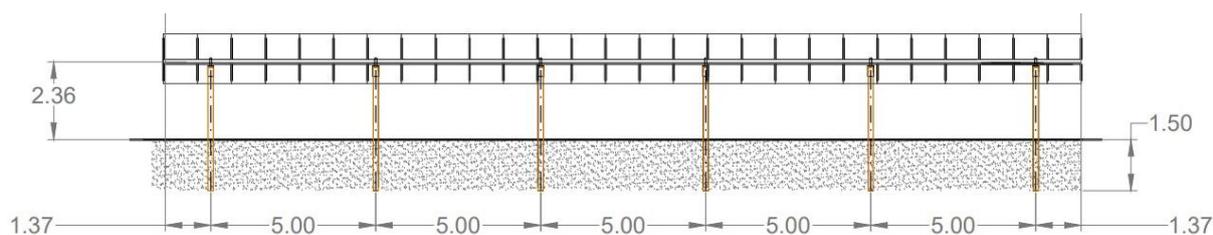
Stralcio prospetto struttura di supporto 2x26
